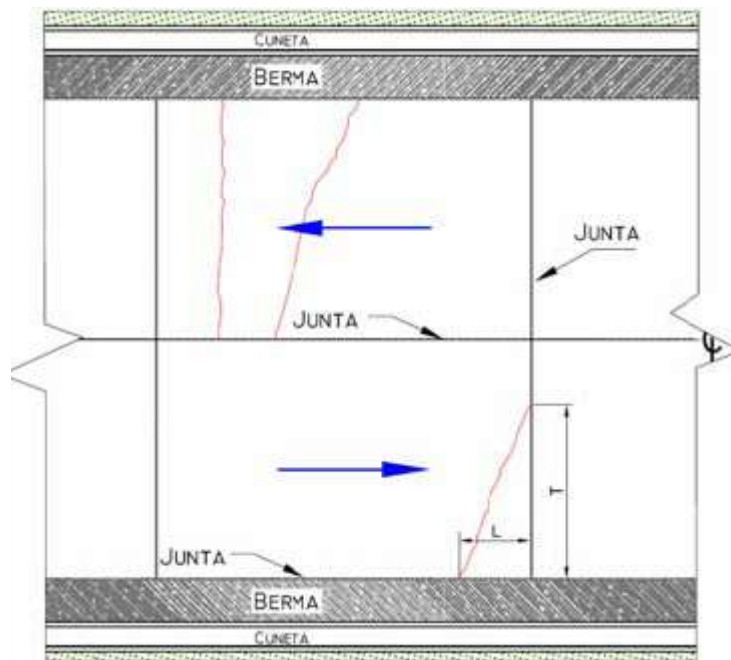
Vista en Planta de las Grietas Transversales.
